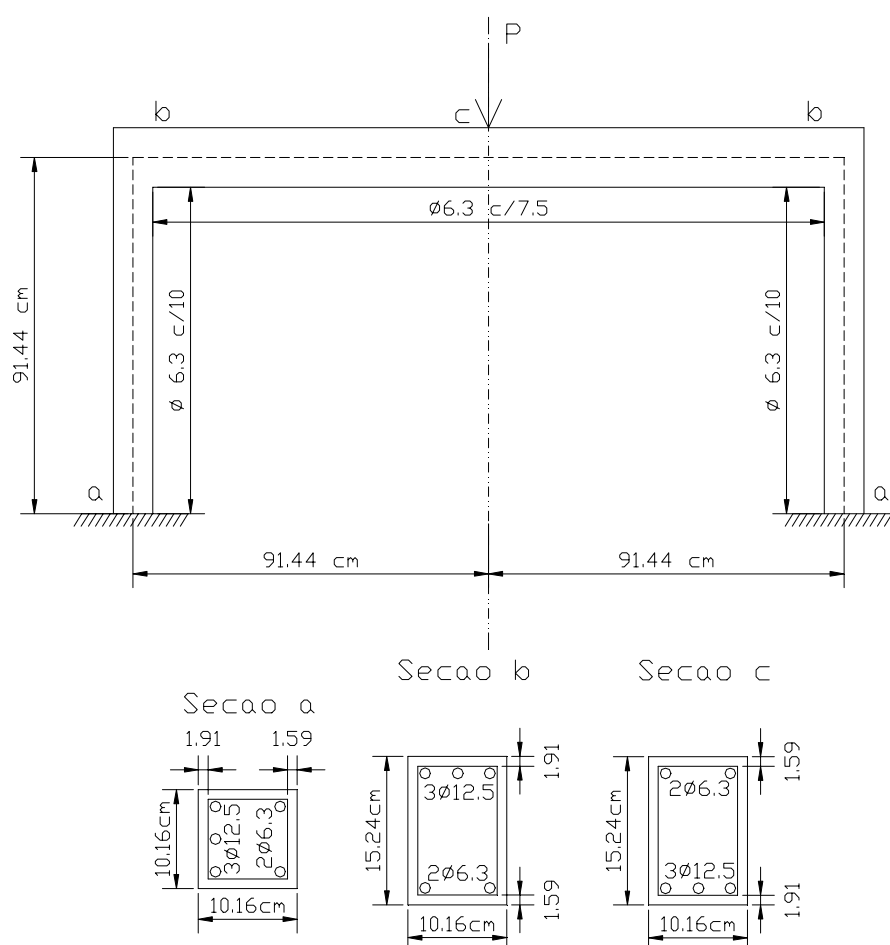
Pórtico ensaiado por Wilby e Pandit
